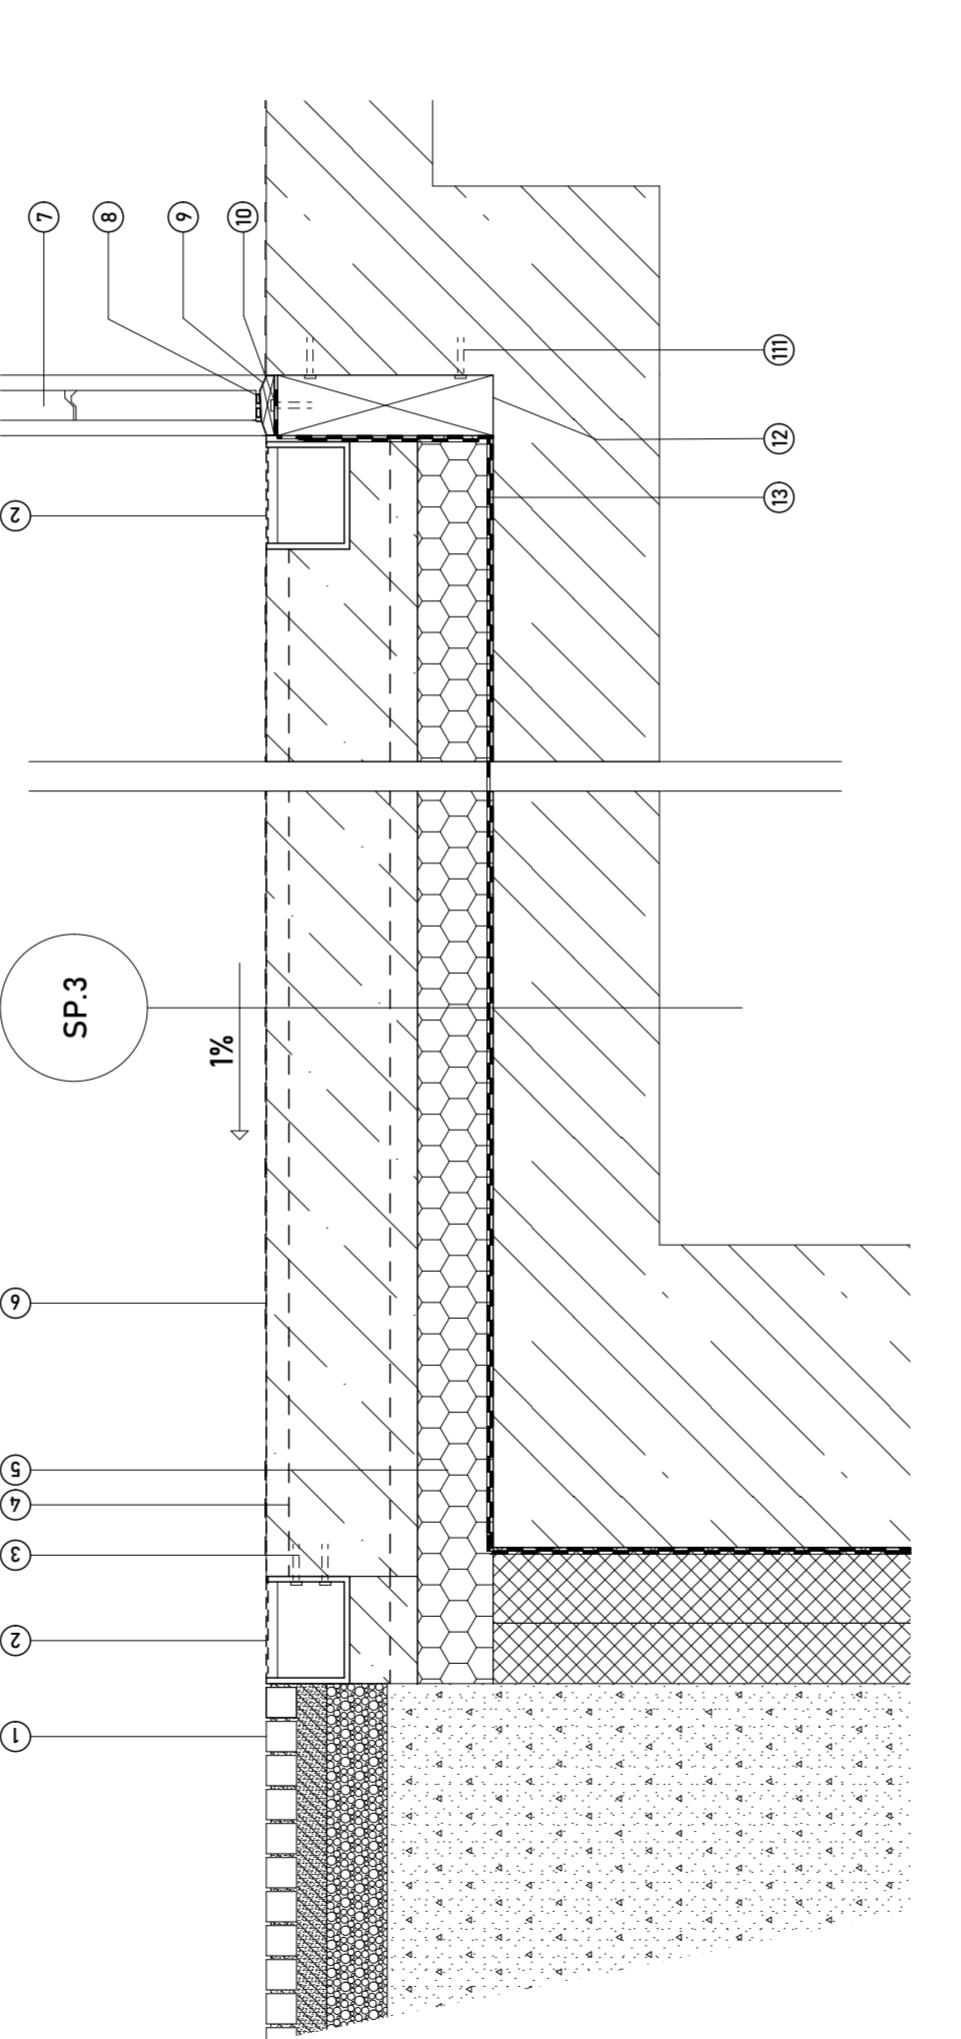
DETAIL NADPRAŽÍ/GARAŽOVÝCH VRAT DT.4
